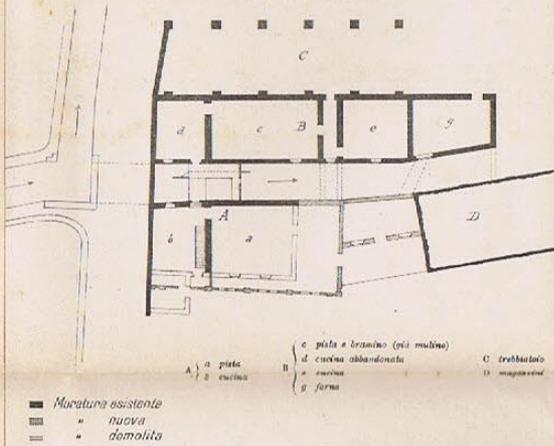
Pianta del pianterreno — Scala 1:400.
